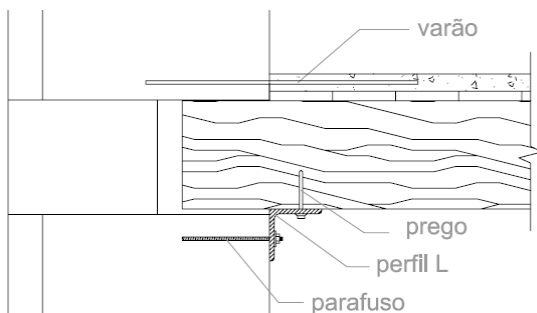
Ligação do piso madeira-betão (S4).
